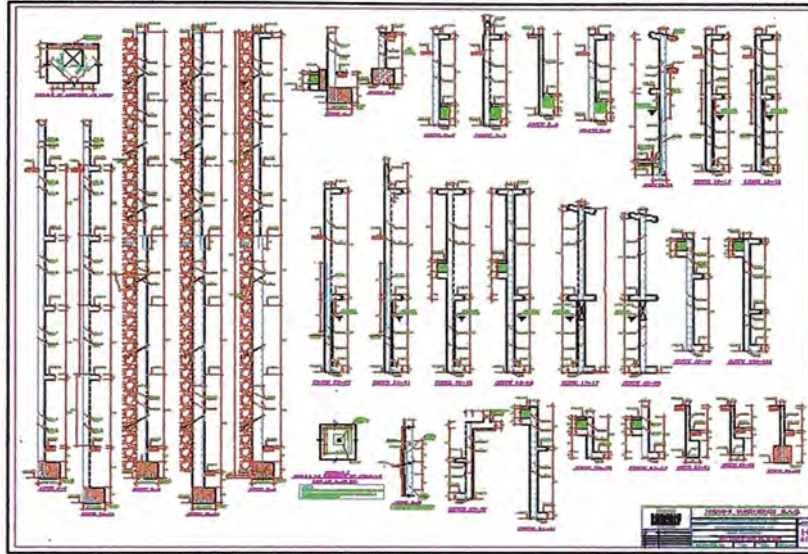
Planos de cimentación y elevaciones de muro de contención
